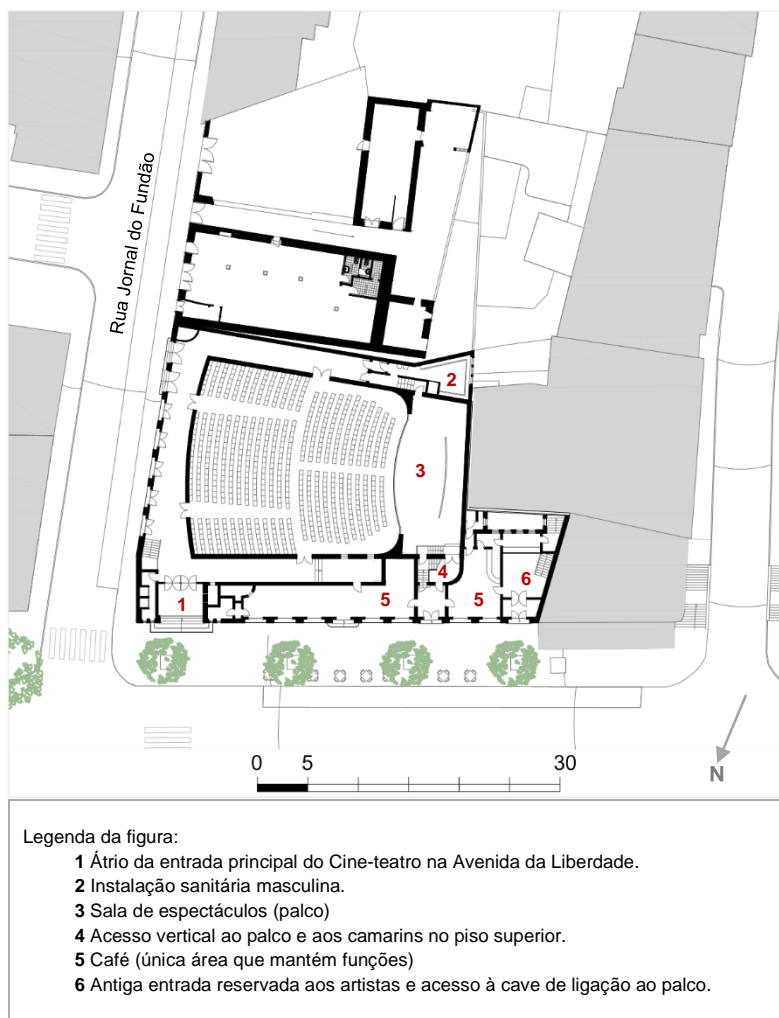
Planta original do piso térreo do Cine-teatro e localização dos usos.
